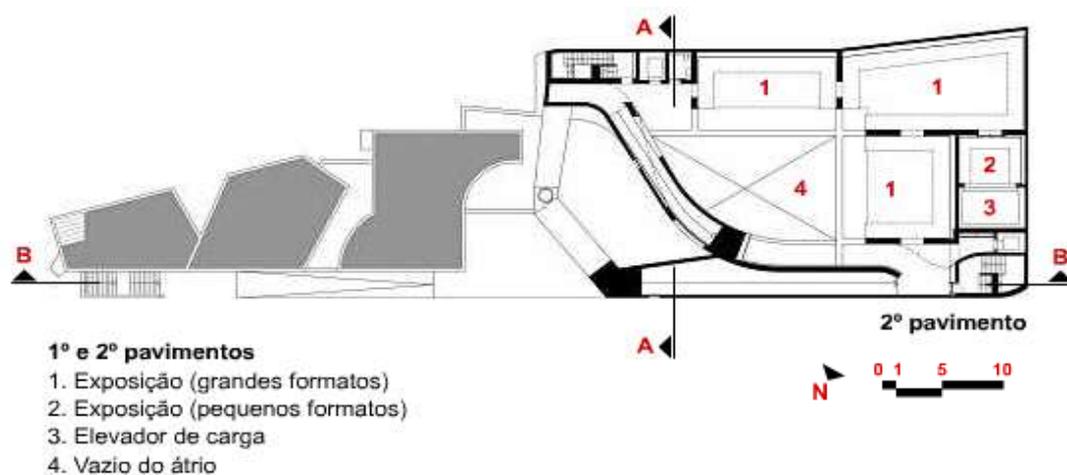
Planta baixa do 2º pavimento (Fonte: ARCOWEB, 2011)
